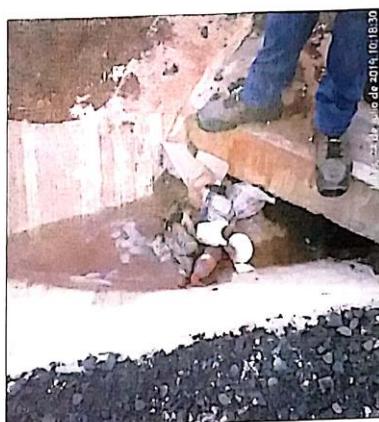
Desechos en la cuneta que va al alcantarillado
